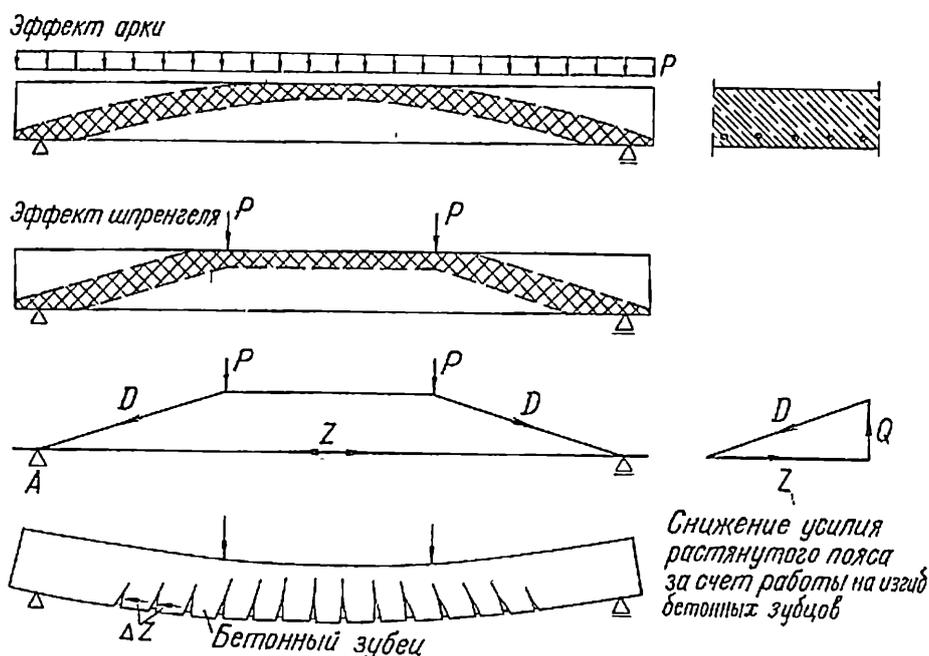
1. Пологие сжатые пояса у плит без арматуры, работающей на скалывание
